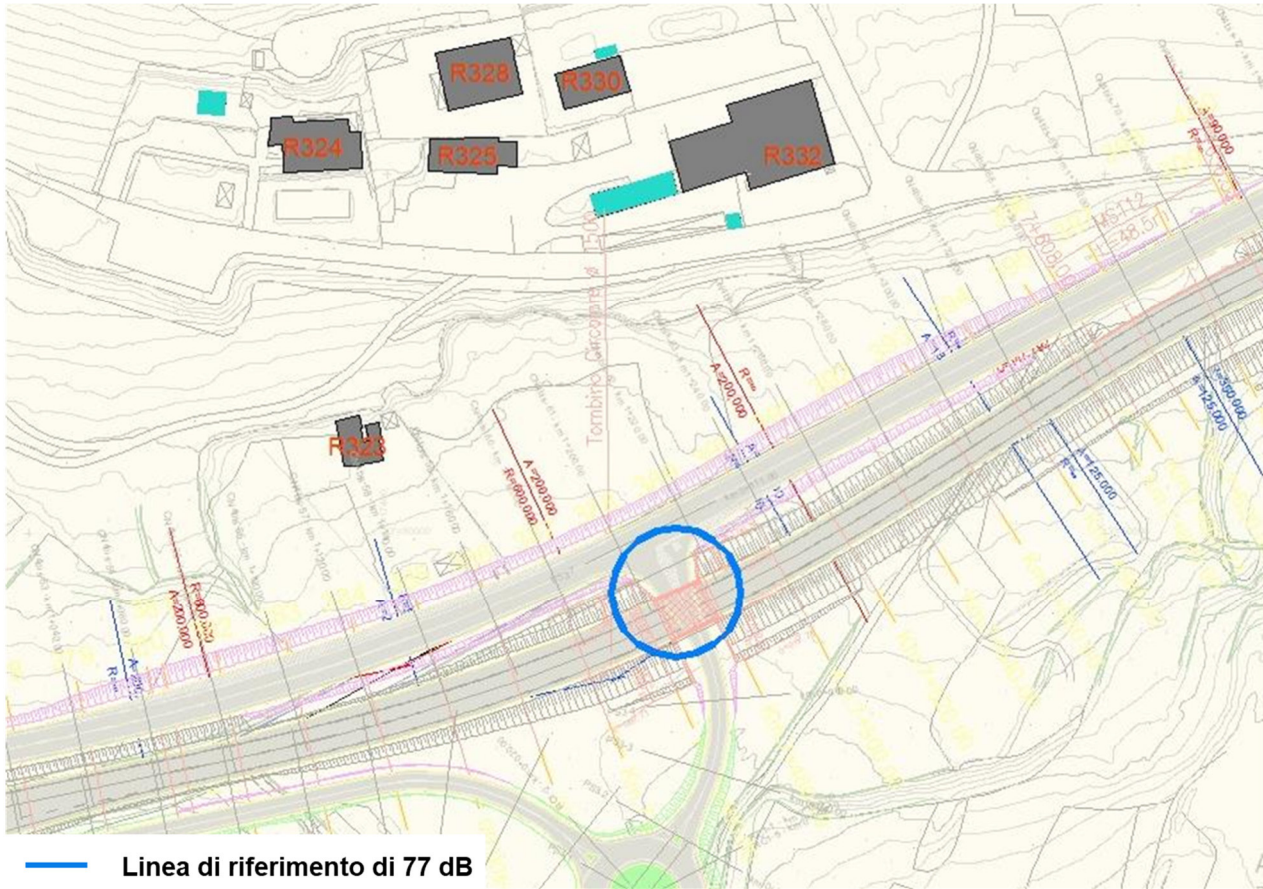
Stralcio planimetrico con indicazione della linea di riferimento dei 77 dB per il Sottovia Scatolare ST.002 a Barisciano
